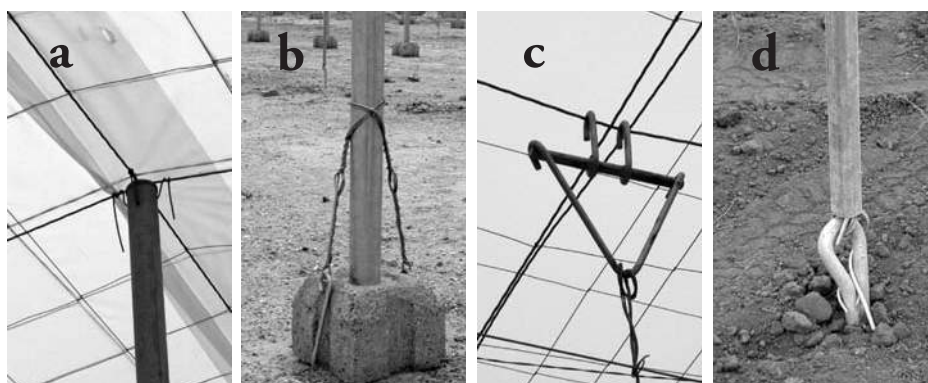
Elementos estructurales de un invernadero tipo Almería con unión de las cordadas longitudinales y transversales a un poste central mediante garroteras (a), anclaje de los pies derechos (b), sujeción de las canaletas a las cordadas transversales (c) y anclaje de los amagados a los «muertos» (d)
